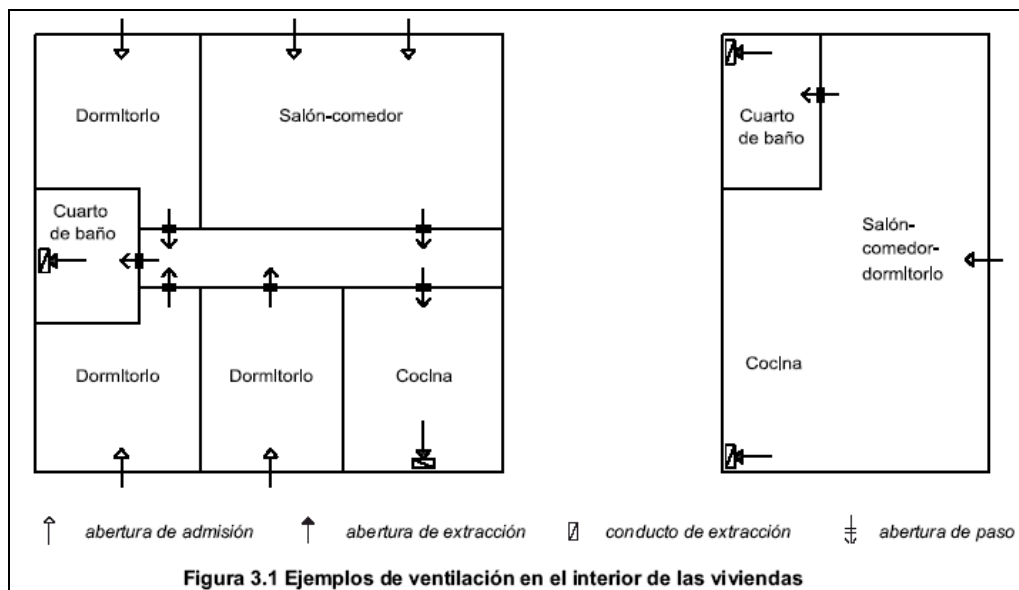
Ejemplos de ventilación en el interior de las viviendas
